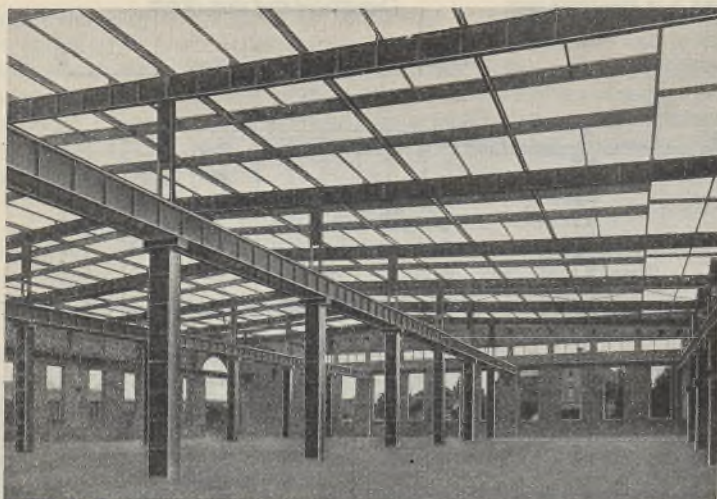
Montagehalle fertig montiert ohne Dachdeckung.
